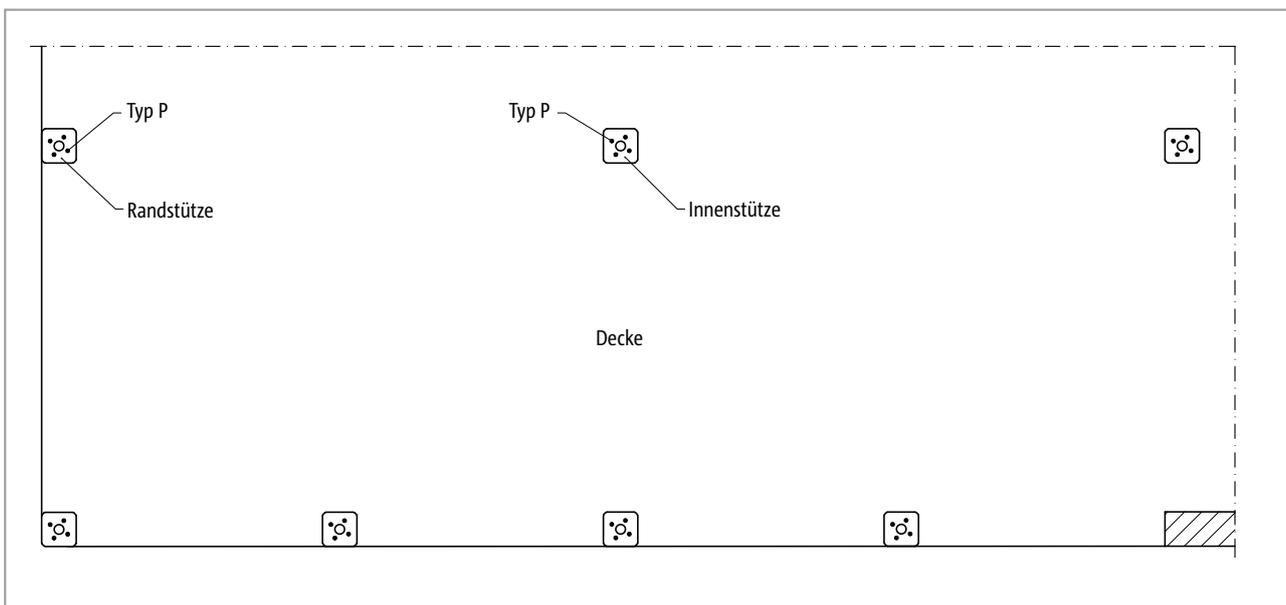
Schöck Sconnex® Typ P: Elementanordnung im Grundriss
